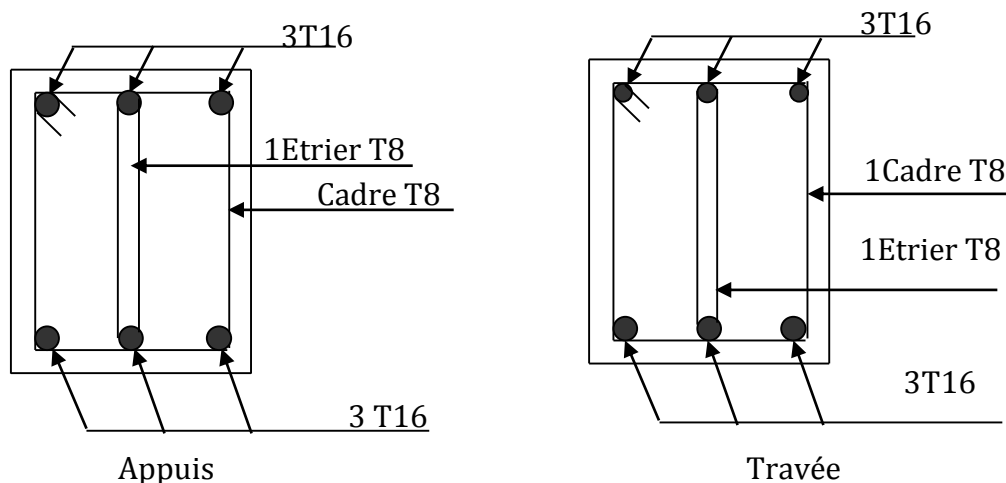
2 : Poutre secondaire du RDC et étage courant
